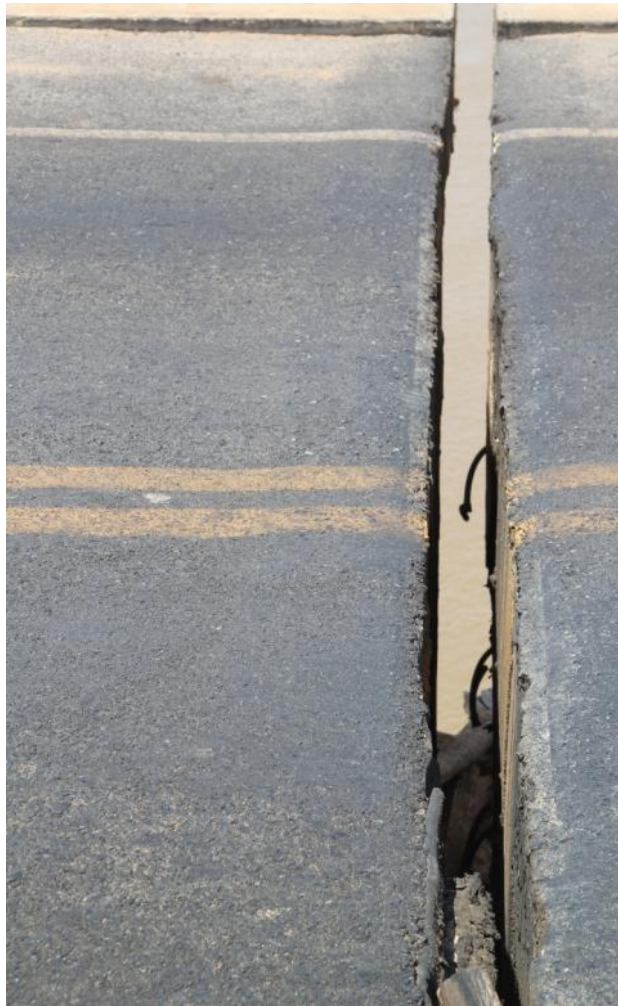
Detalhe do espaço deixado com o afastamento das juntas
